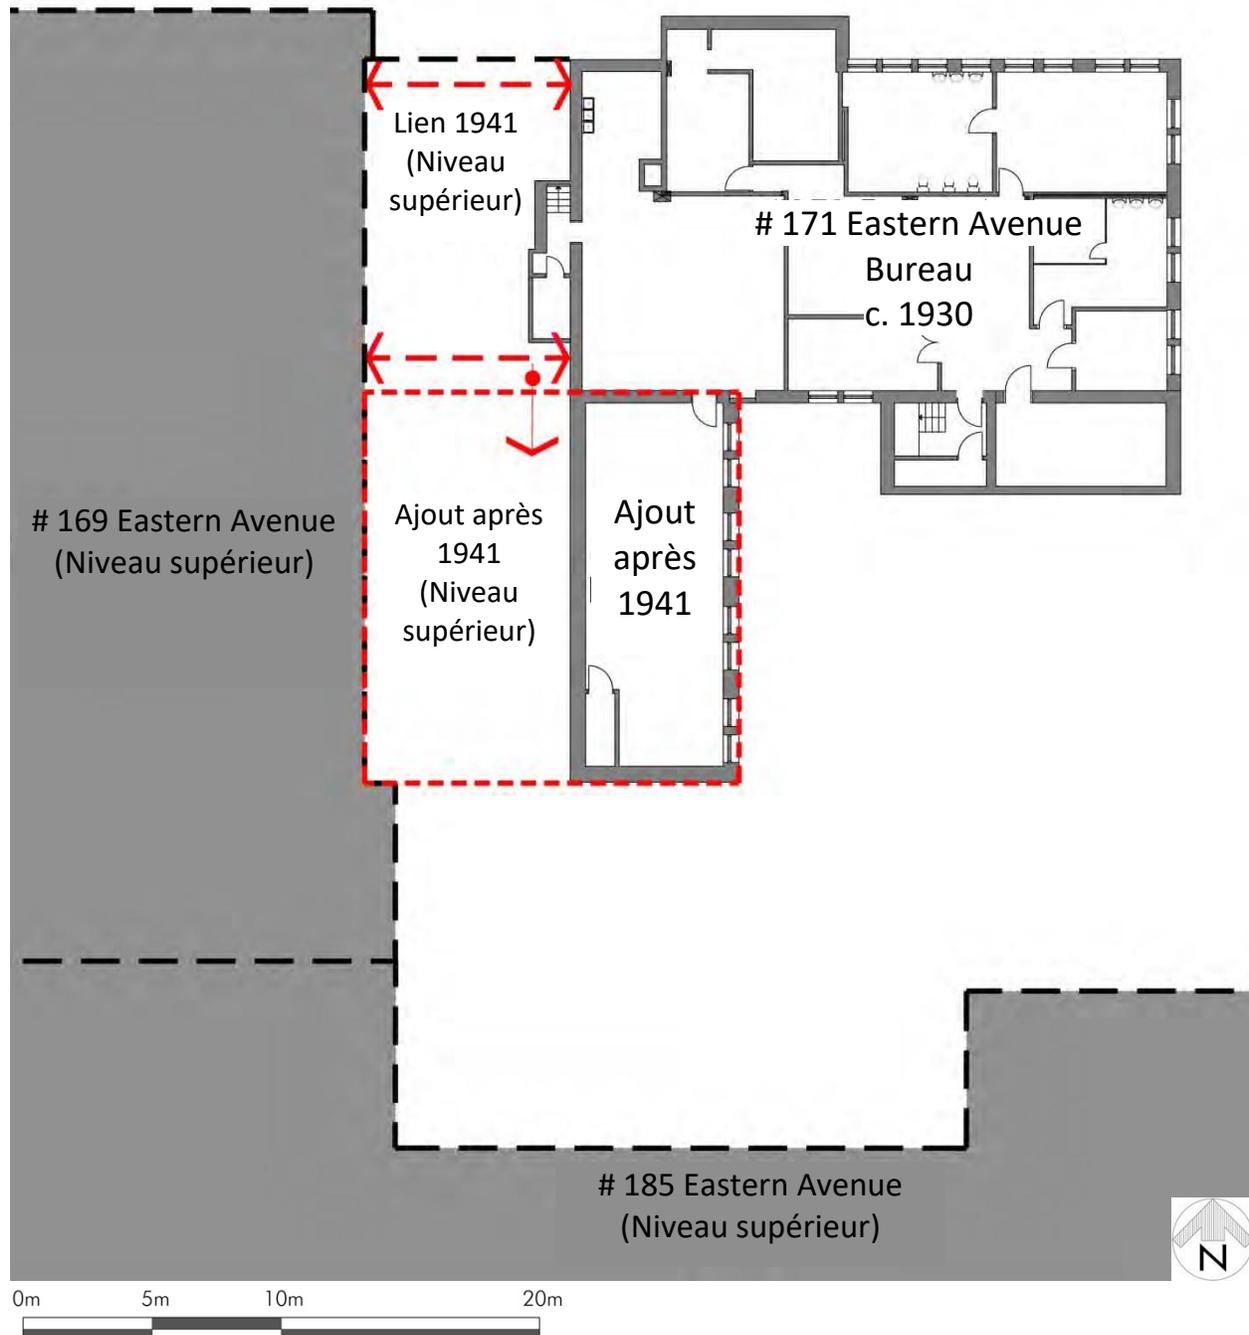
171 avenue Eastern – Plan du sous-sol des bureaux.
